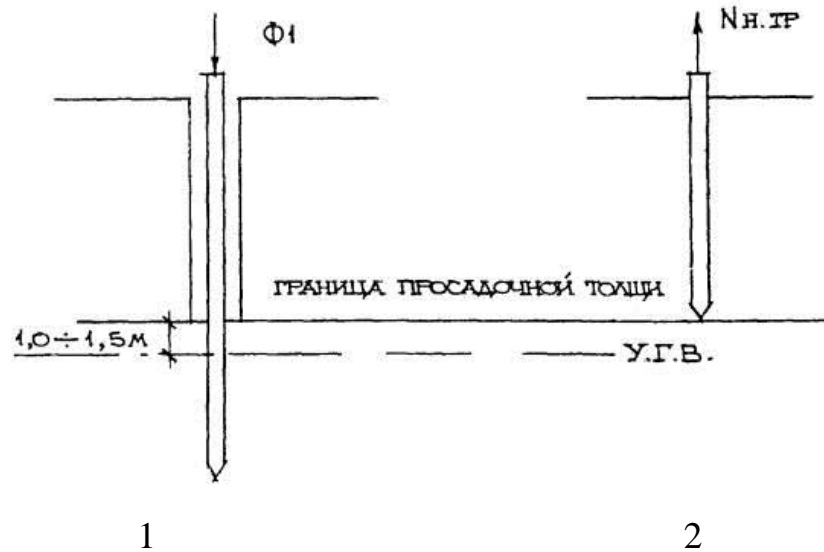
УГВ и граница просадочной толщи практически совпадают: 1) схема испытания сваи ниже просадочной толщи; 2) схема испытания сваи на выдергивание из сваи просадочной толщи
